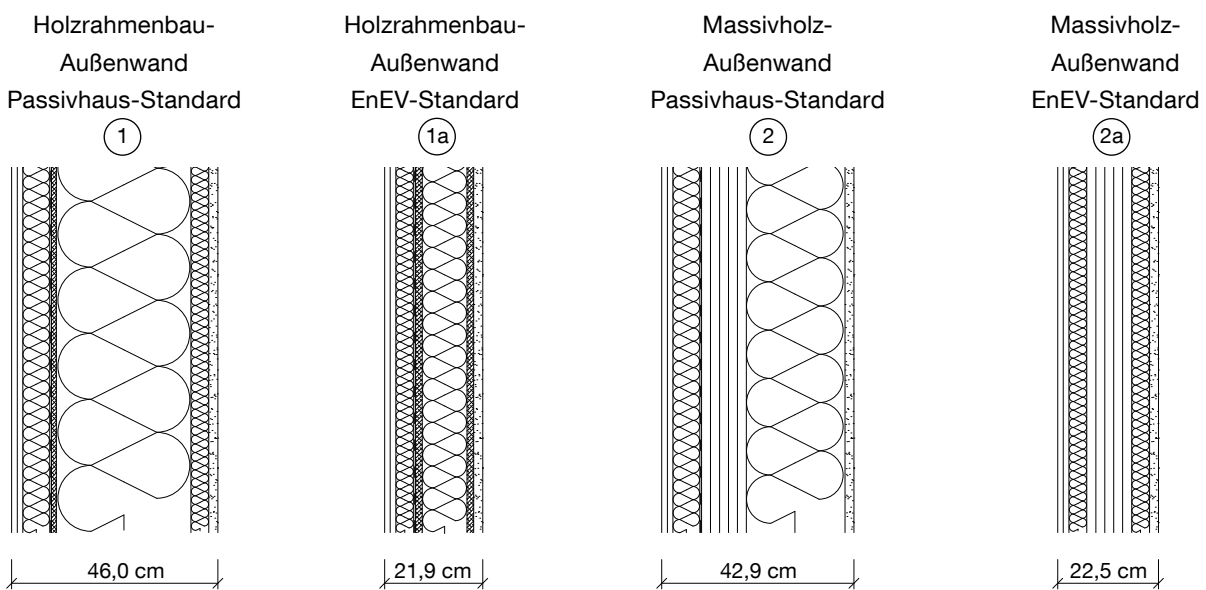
Alternative Außenwandaufbauten in Holzbauweise
